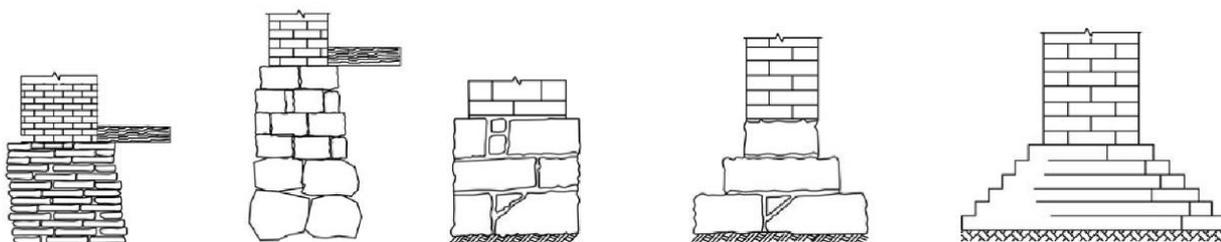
Конструкции столбчатых фундаментов для малоэтажных деревянных и мазанковых бесподвальных зданий [4]
